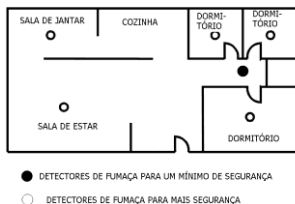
Locais de instalação para detectores de fumaça e calor em apartamentos ou casas para uma família com apenas uma área de dormitório.
